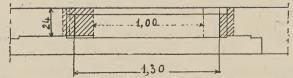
3° étage; petit salon, plan et élévation de la baie transformée dans la brique apparente.
